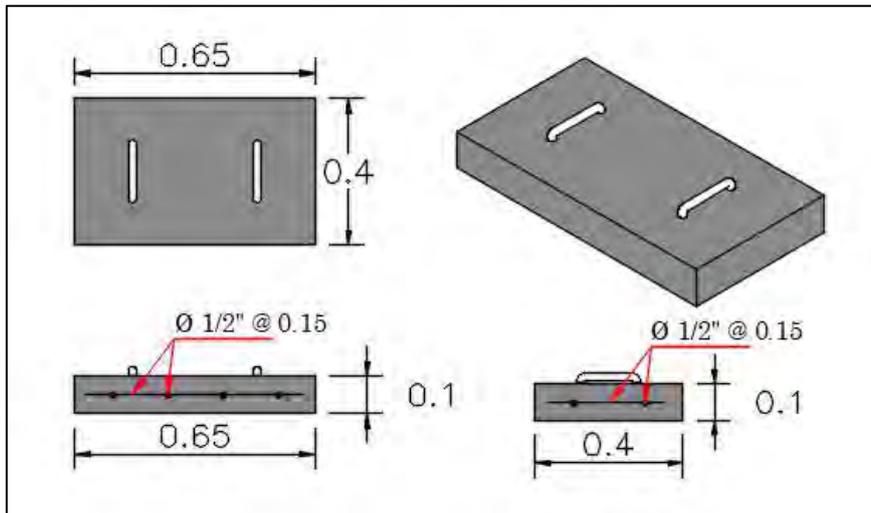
Detalle de las tapas de concreto a usar en el proyecto
